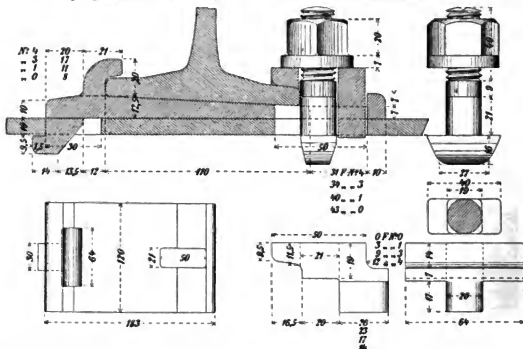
Grundriß der Hakenplatte. M. 1 : 5.
